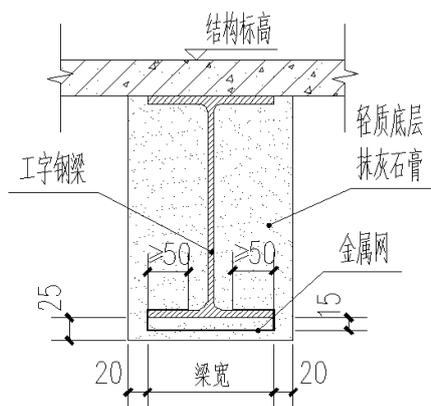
钢梁的轻质底层抹灰石膏防火做法
